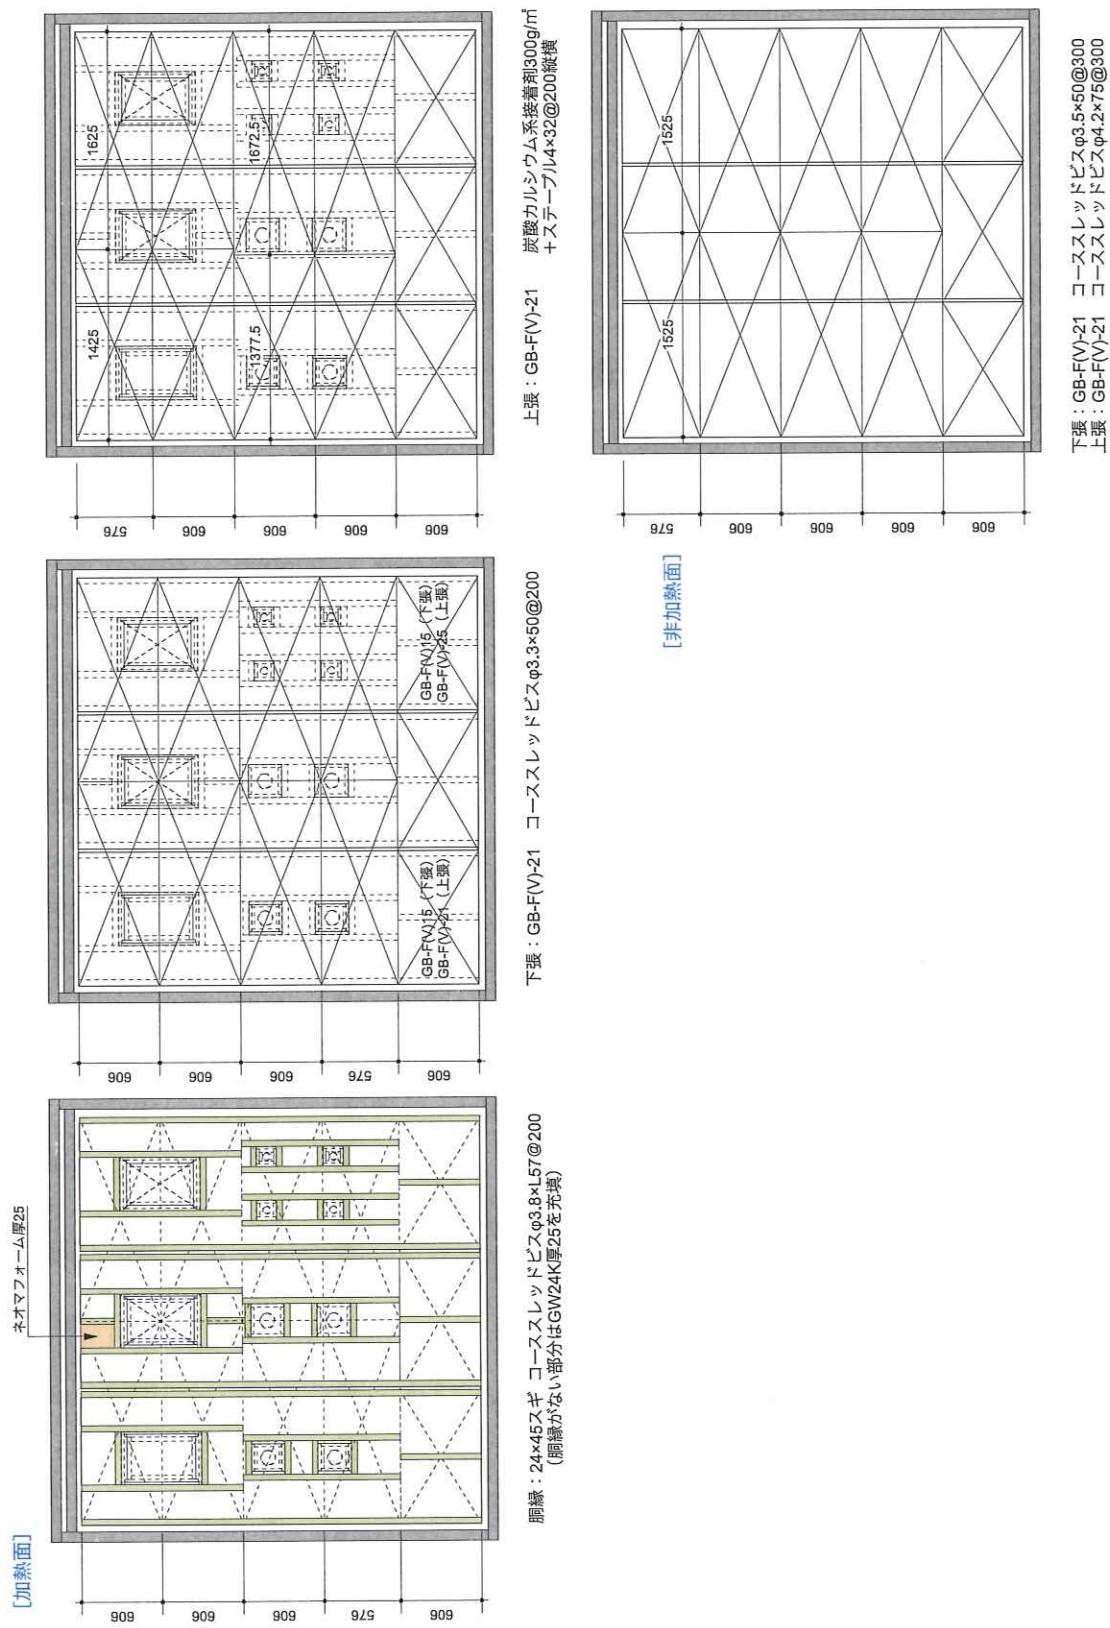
試験体 3 の構造・寸法・割付 (単位 : mm)
